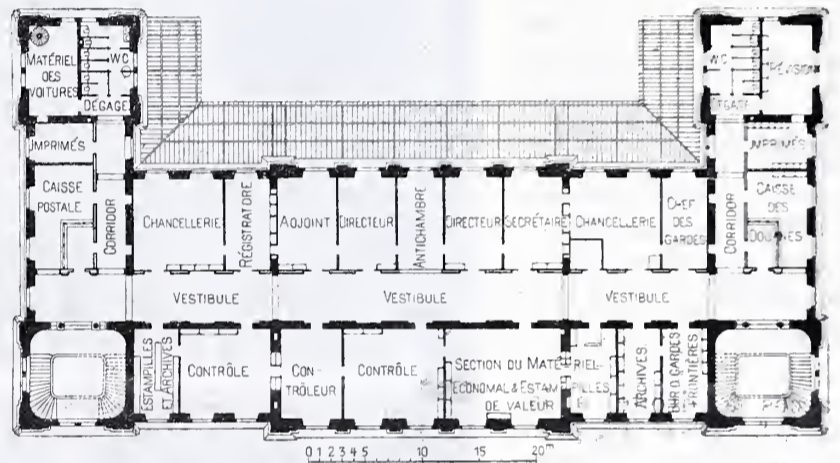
Plan du premier étage. — Echelle 1 : 800.
